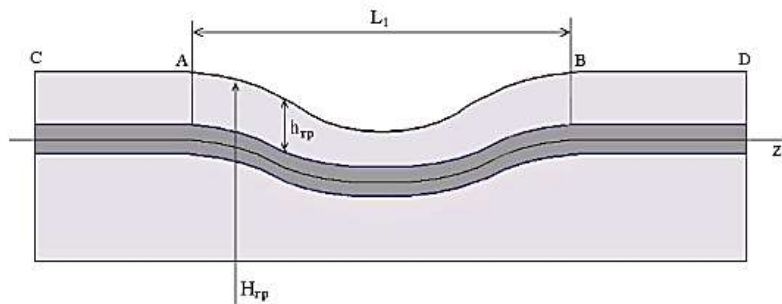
Схема состояния трубопровода в зоне просадки грунта
